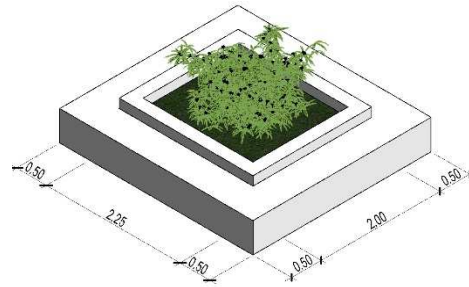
Planta y elevación de diseño de banca-macetero de la plaza central.
